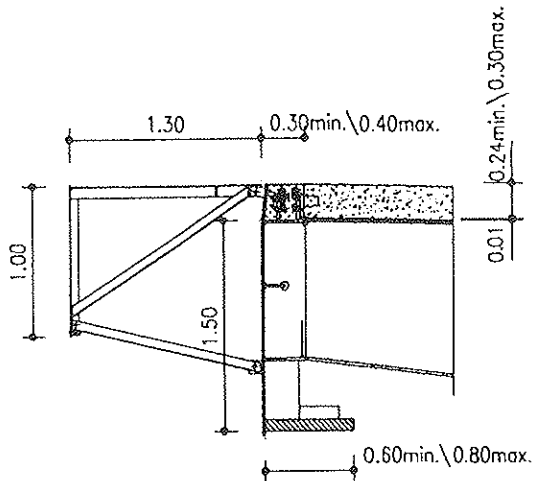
Puente Atirantado. Detalle de viga longitudinal con estabilizador aerodinámico.
